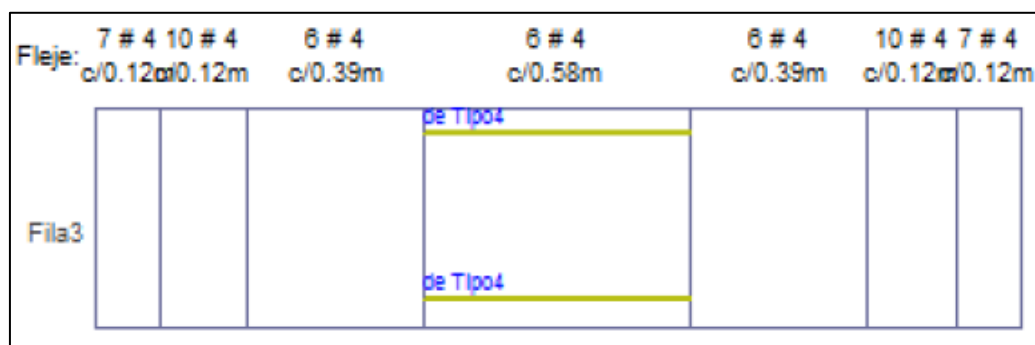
Detalle del despiece en la sección longitudinal de una viga.
